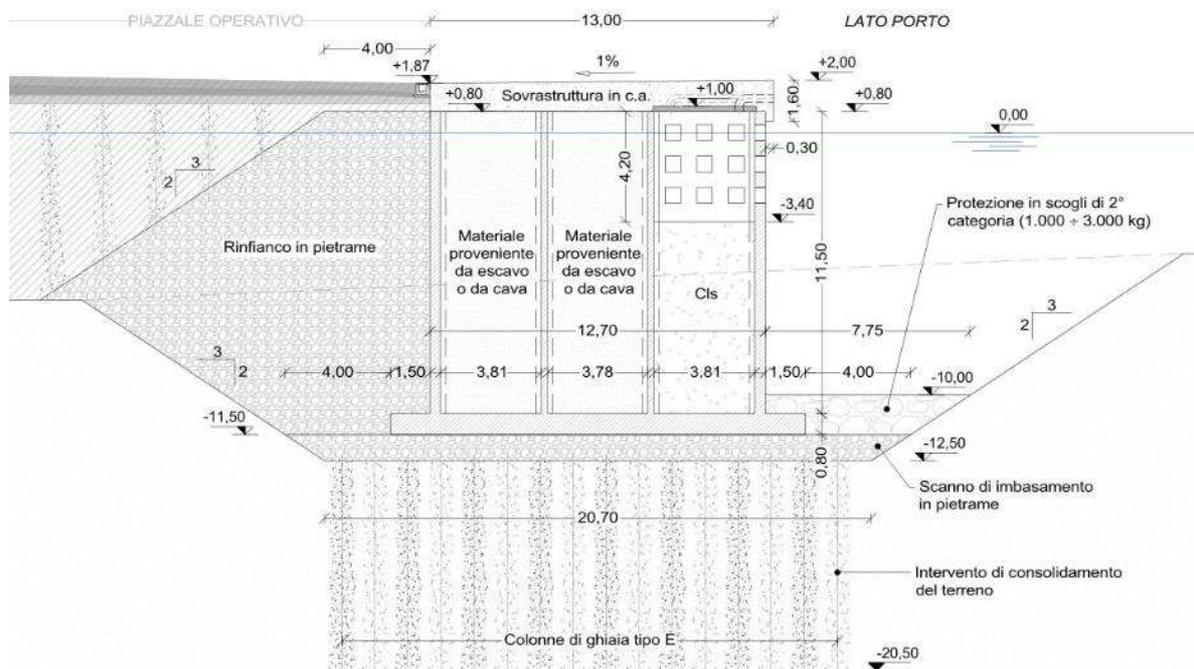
Cassone n°1 (muro di sponda): sezione tipo
